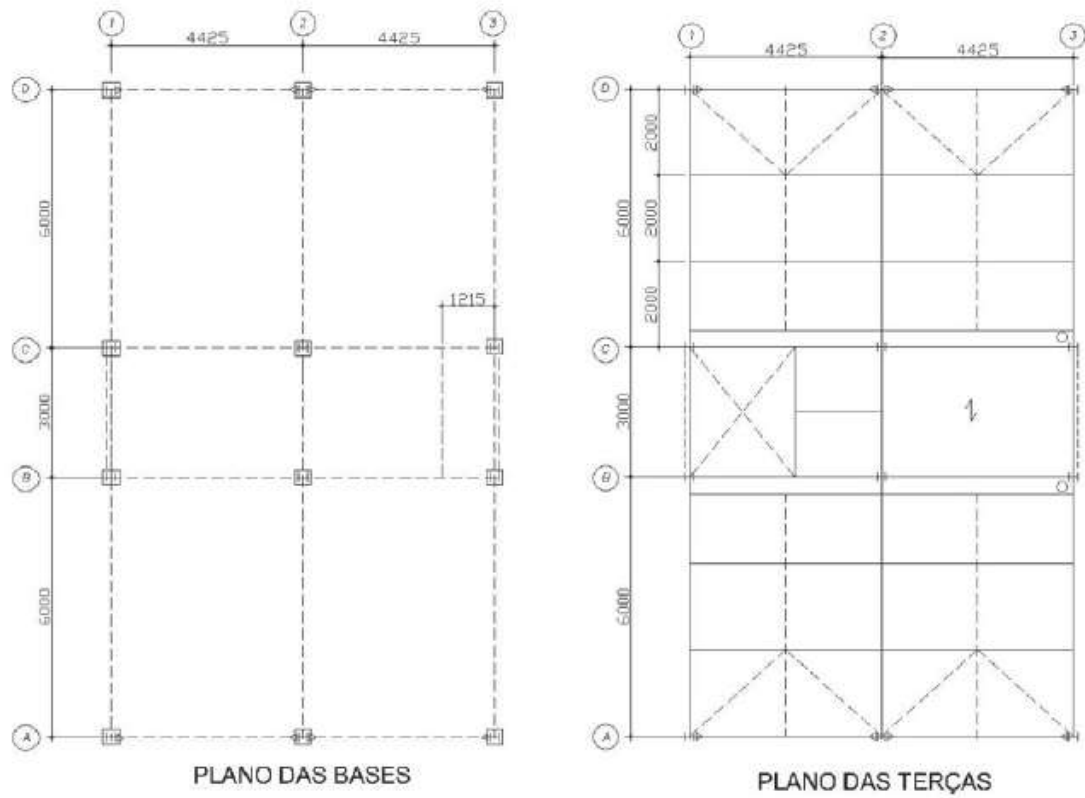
Planta de plano das bases e terças. Fonte: INSTITUTO AÇO BRASIL et al., 2011.
